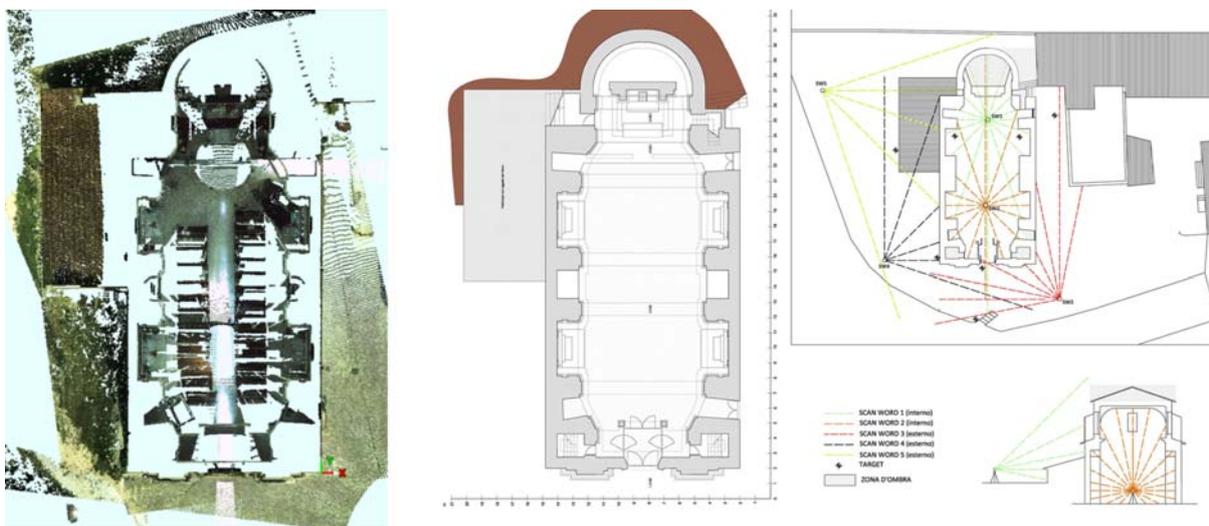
Chiesa di Santa Croce ad Antrosano. Sezione orizzontale della nuvola di punti complessiva, planimetria di rilievo, progetto di ripresa con il laser scanner 3D
